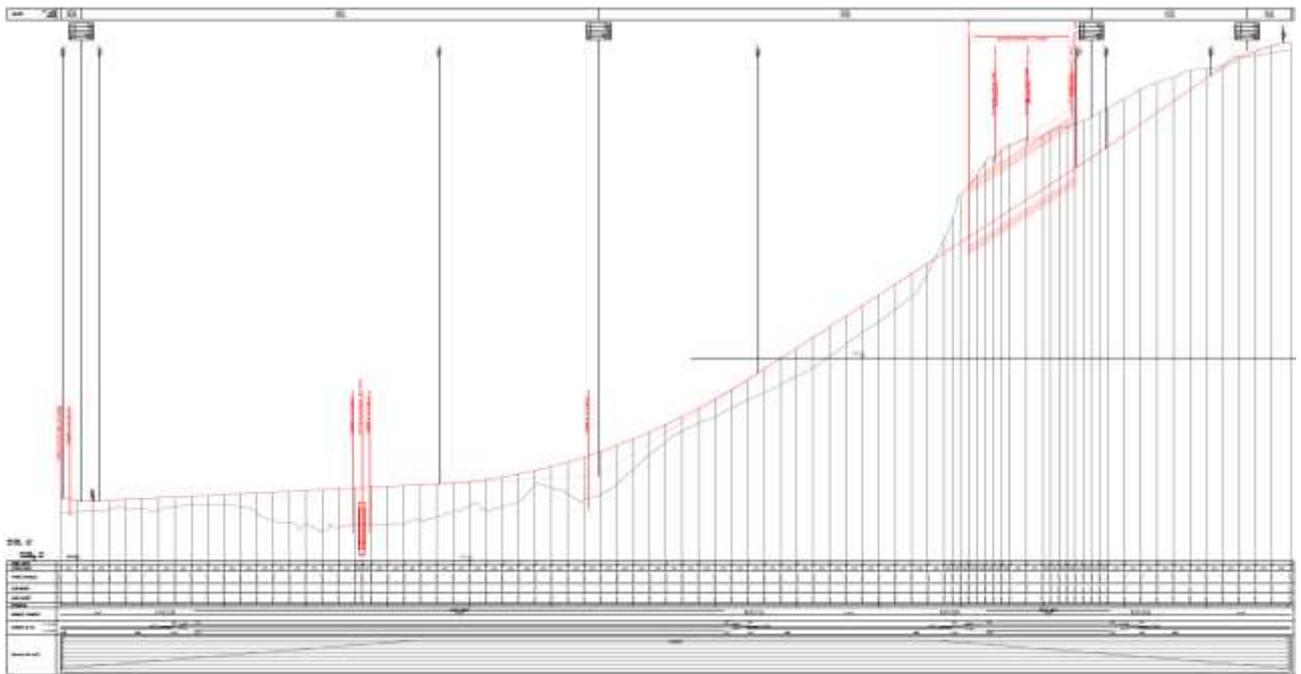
Profilo longitudinale del tratto stradale di nuova realizzazione
